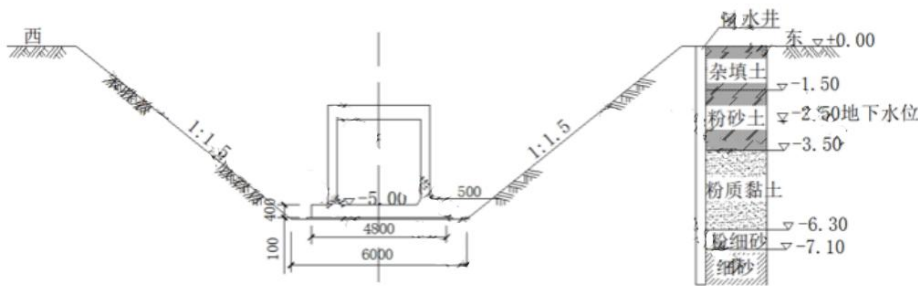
沟槽开挖断面示意图(高程单位:m;尺寸单位:mm)
